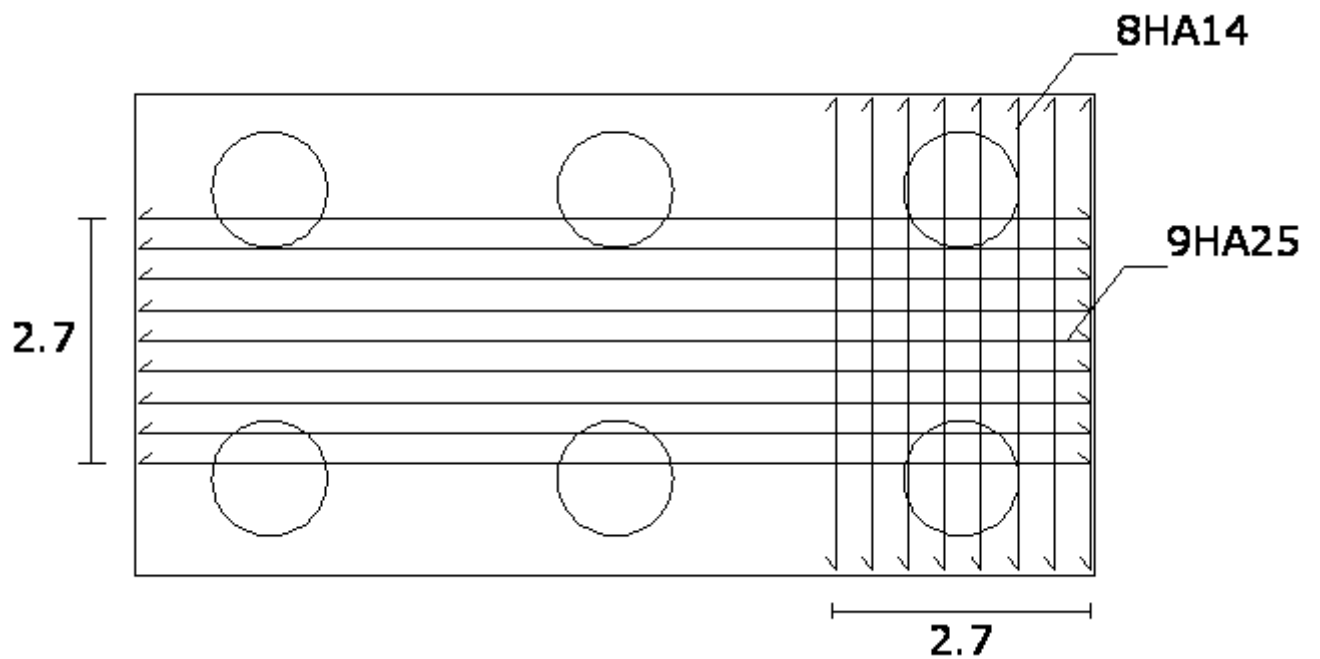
Ferrailage de la semelle en plan (nappe inférieure)
